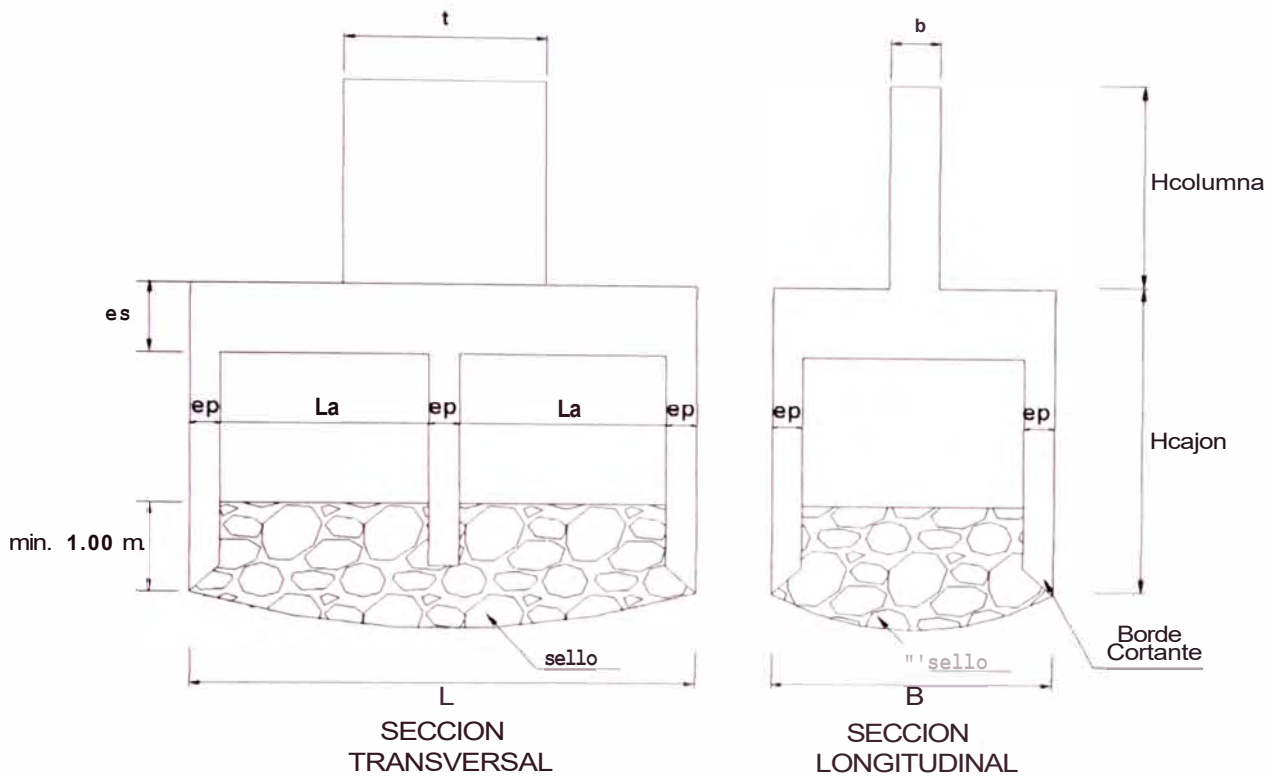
Predimensionamiento del cajón de cimentación
